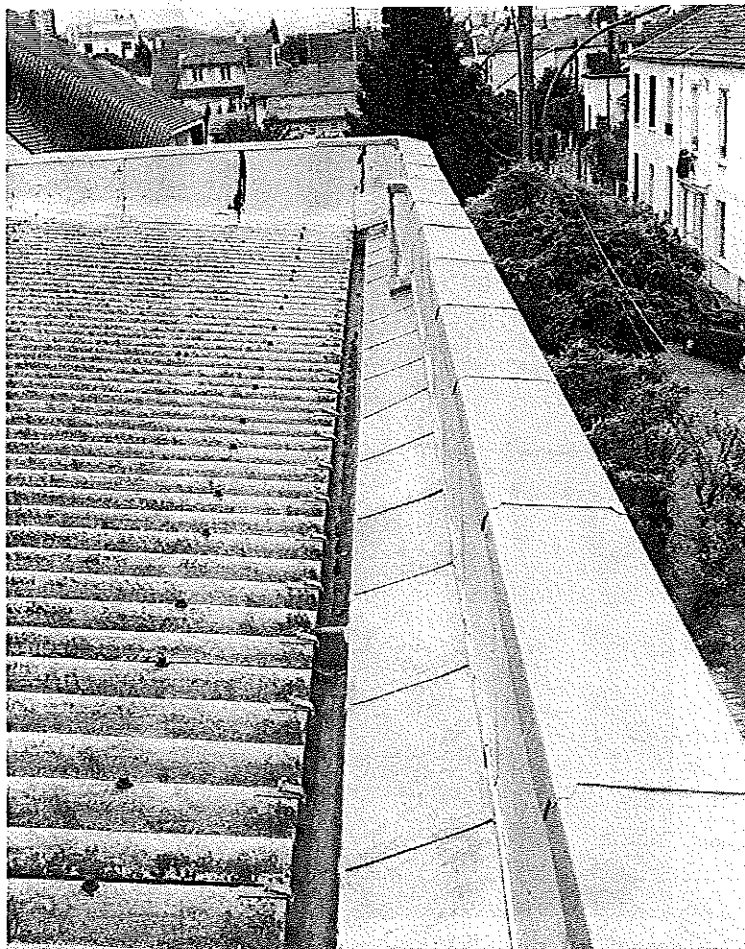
Aspect de l'acrotère après travaux. © J. Putatti
